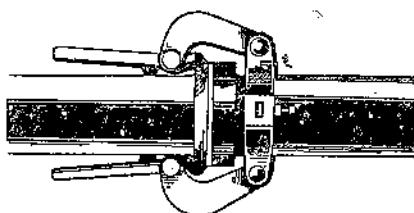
Замки для соединения трубопровода при подаче бетона насосом.
